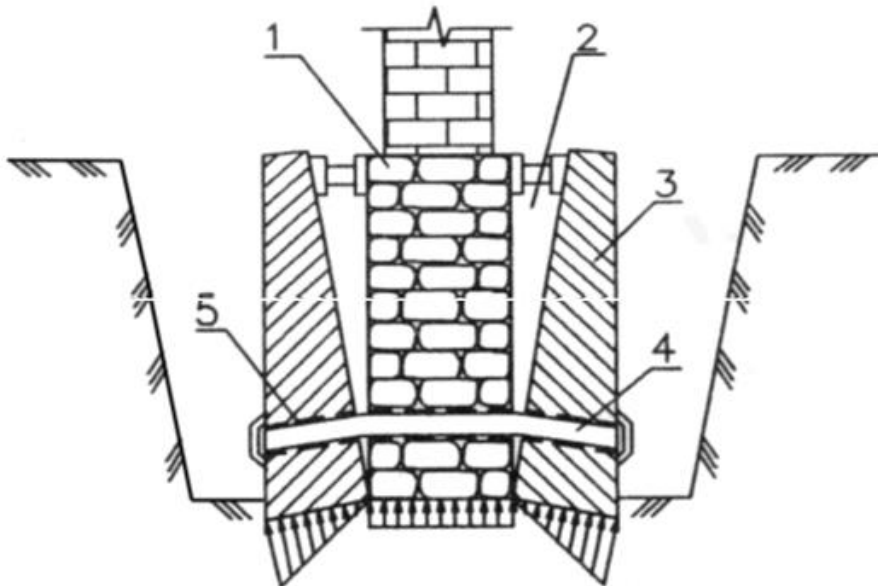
Підсилення фундаментів додатковими блоками, обжимаються ґрунти основи за їхнього повороту: 1 – існуючий фундамент; 2 – щілина, що утворюється під час повороту блоків; 3 – залізобетонний блок; 4 – анкерне кріплення; 5 – отвори для анкерів
